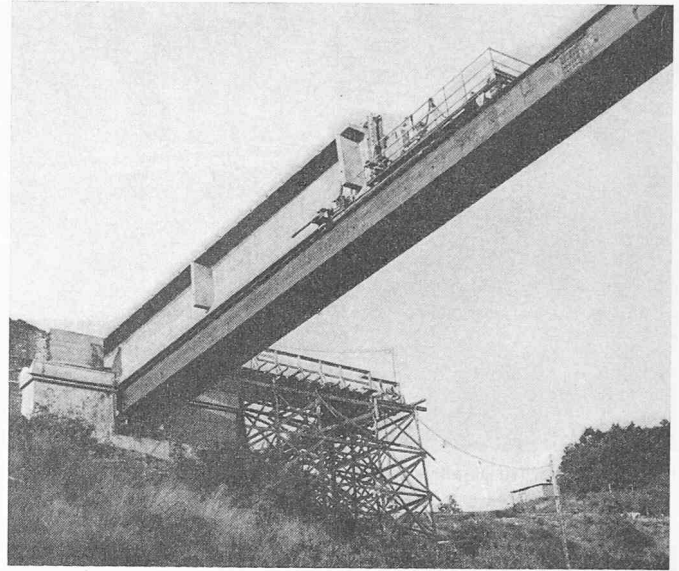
Einfache Montageart für Spannbetonbalken nach Nanning, Luxemburg. Fahrbanträger passiert die Montagebrücke
